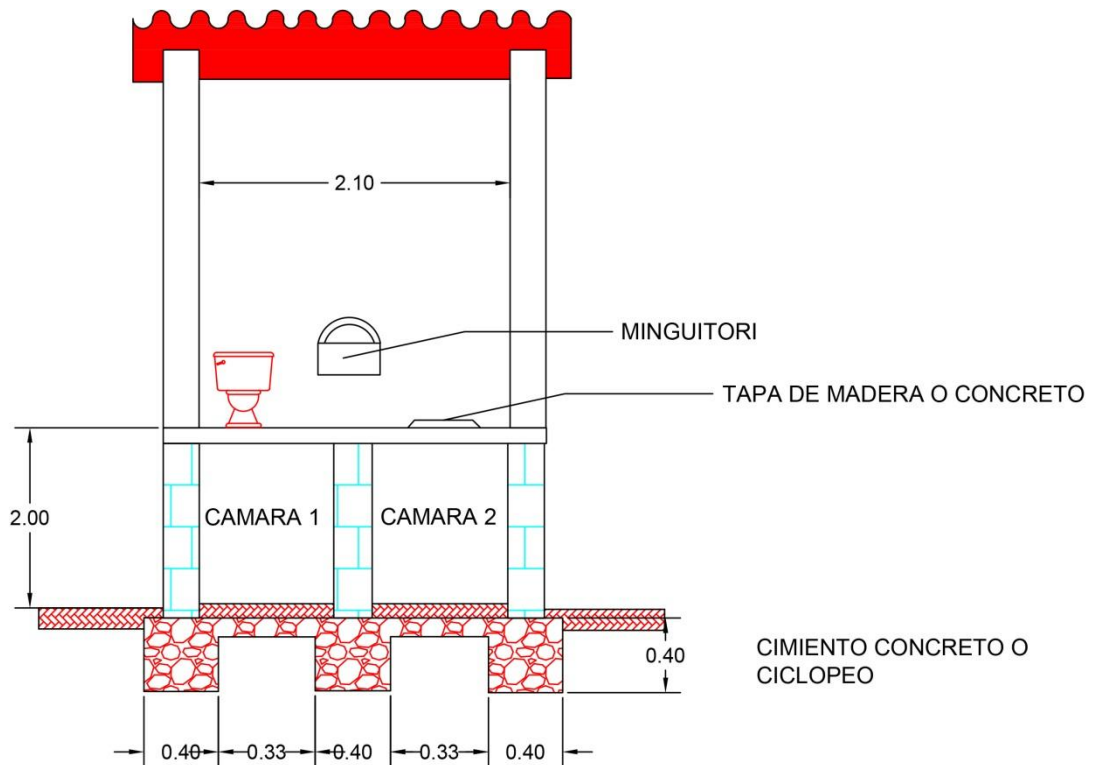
Detalle y dimensionamiento de sección de baño abonero
